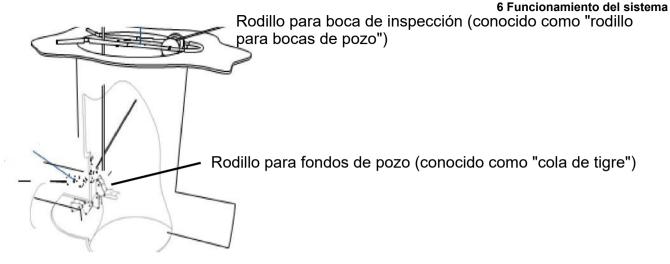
Utilización de rodillos para reducir el desgaste del cable
